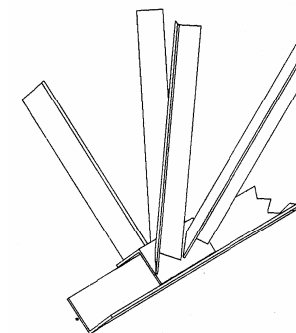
Detalle de la propuesta de uniones soldadas.
